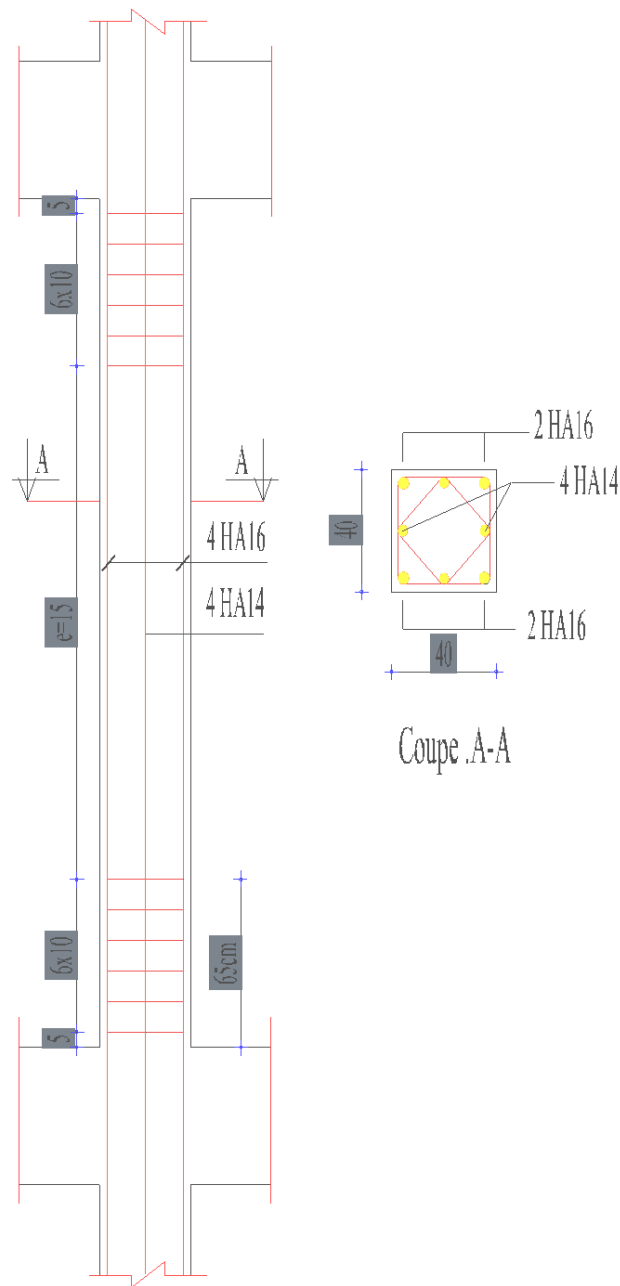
Schéma de ferrailage des poteaux (40 x 40)
